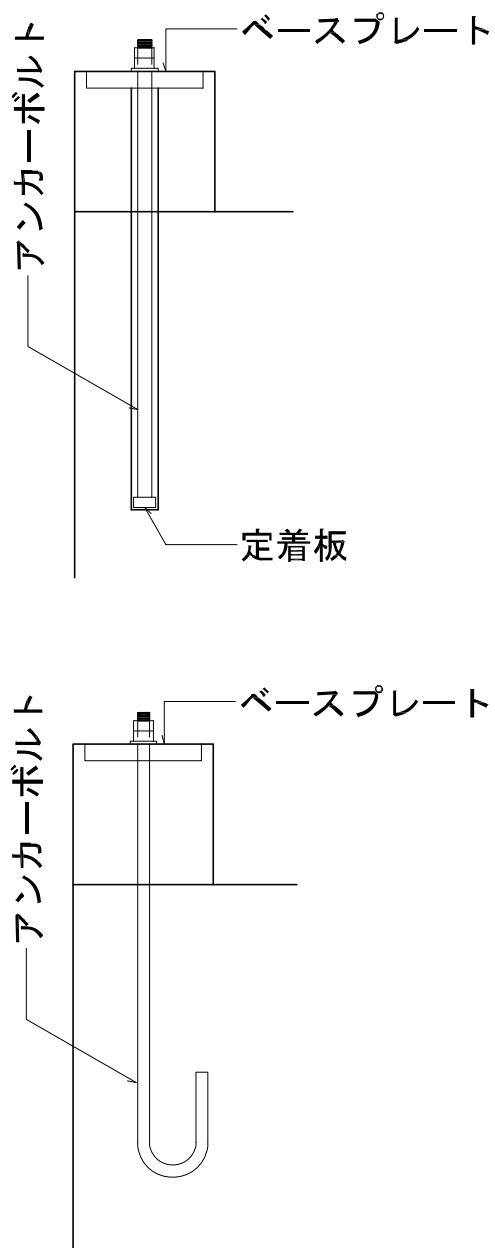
基礎ボルト断面図（一般図，上段：タイプA，下段：タイプB）
